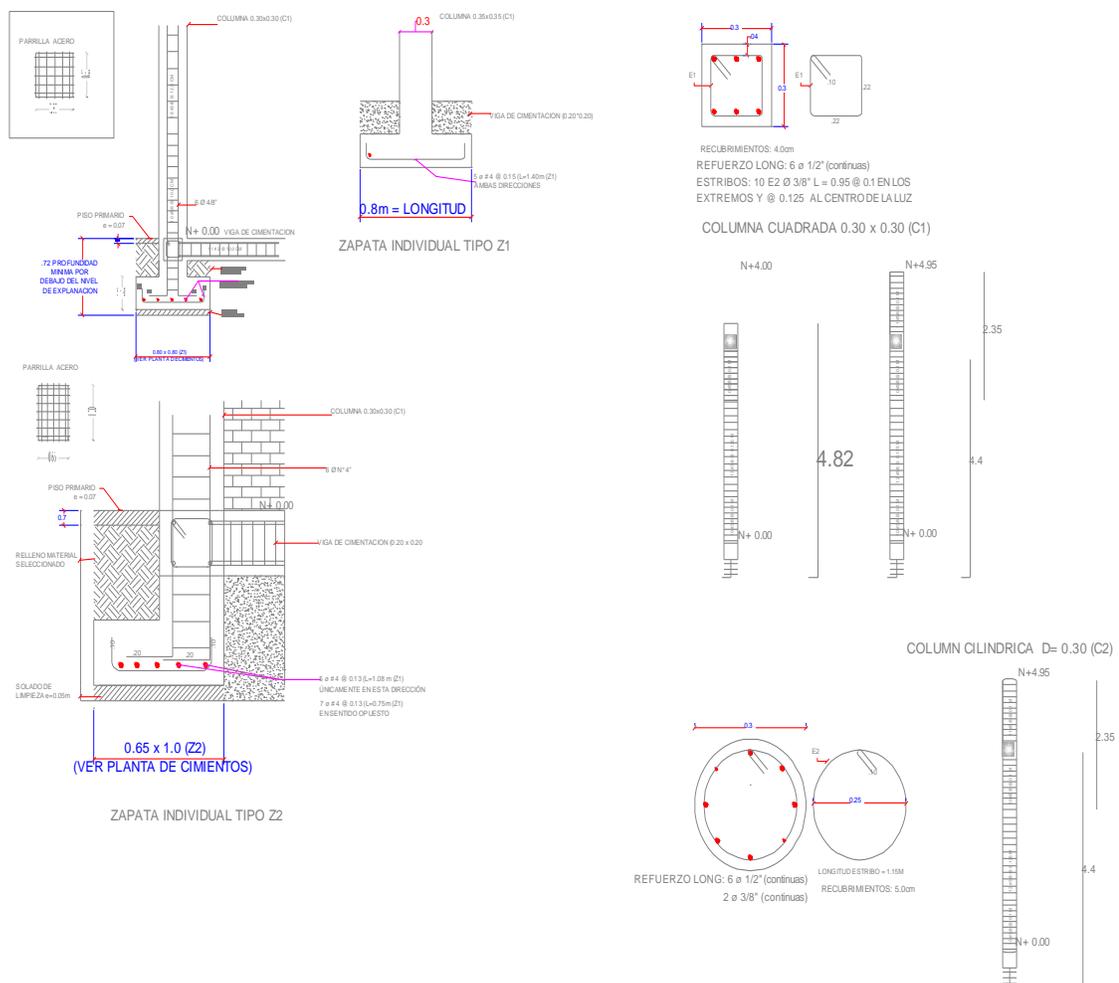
Elementos estructurales de las zapatas y columnas para la iglesia San isidro
